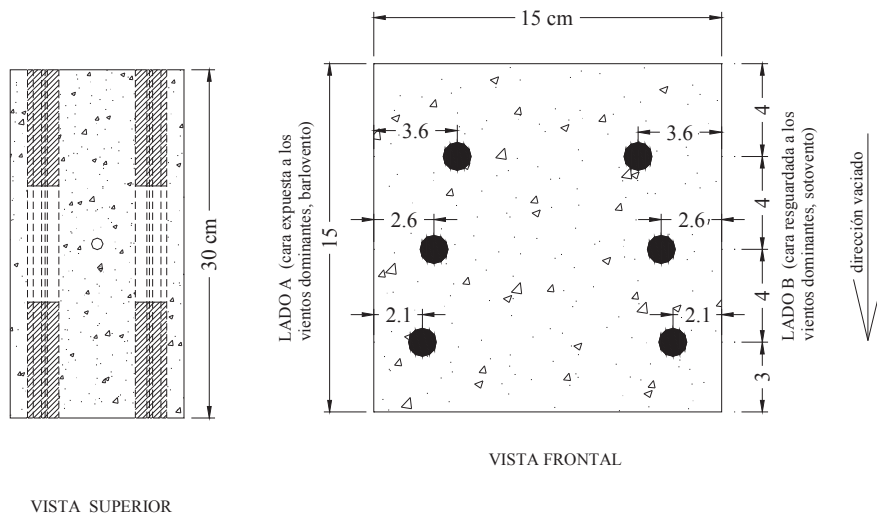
Detalle de la geometría de los ejemplares. Vistas superior y frontal
